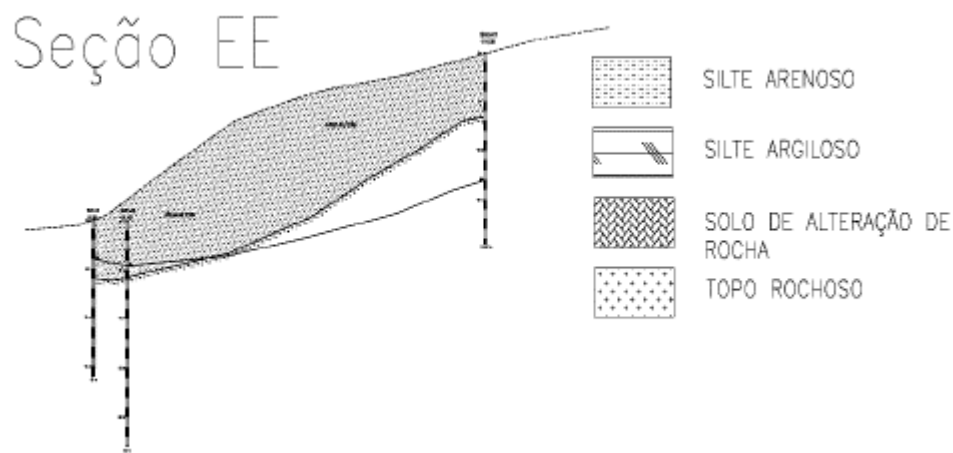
Perfil Geotécnico definido pelas Sondagens Mistas – Seção “EE”
